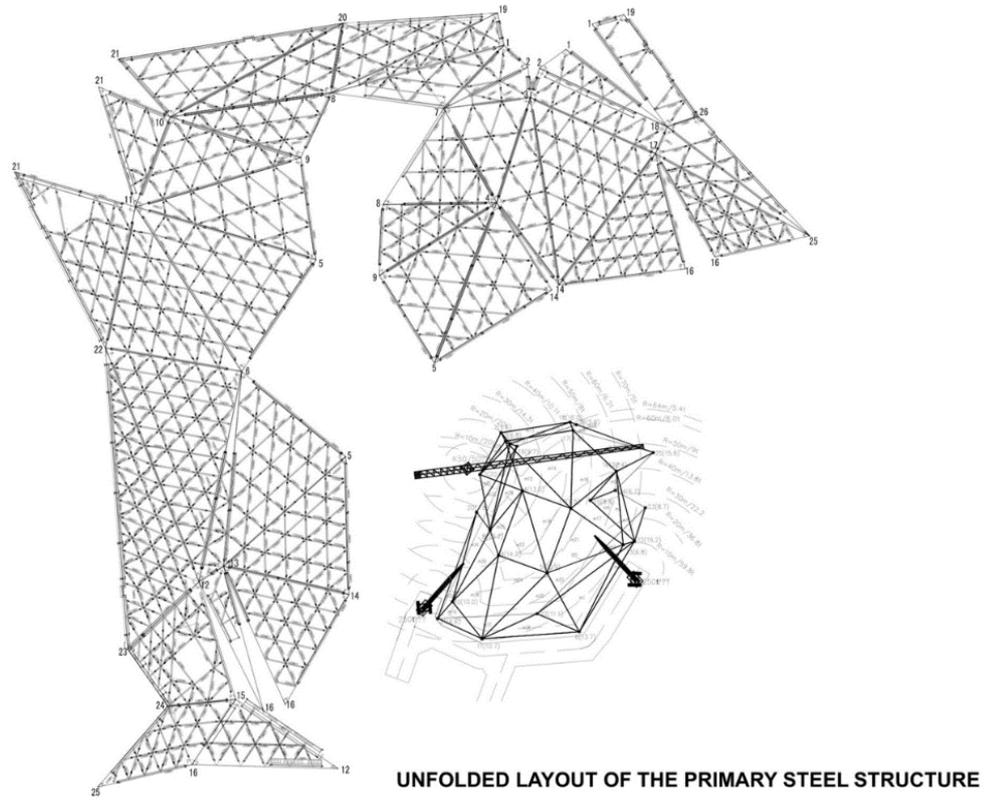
Planimetría estructural del proyecto Opera Guangzhou, China
